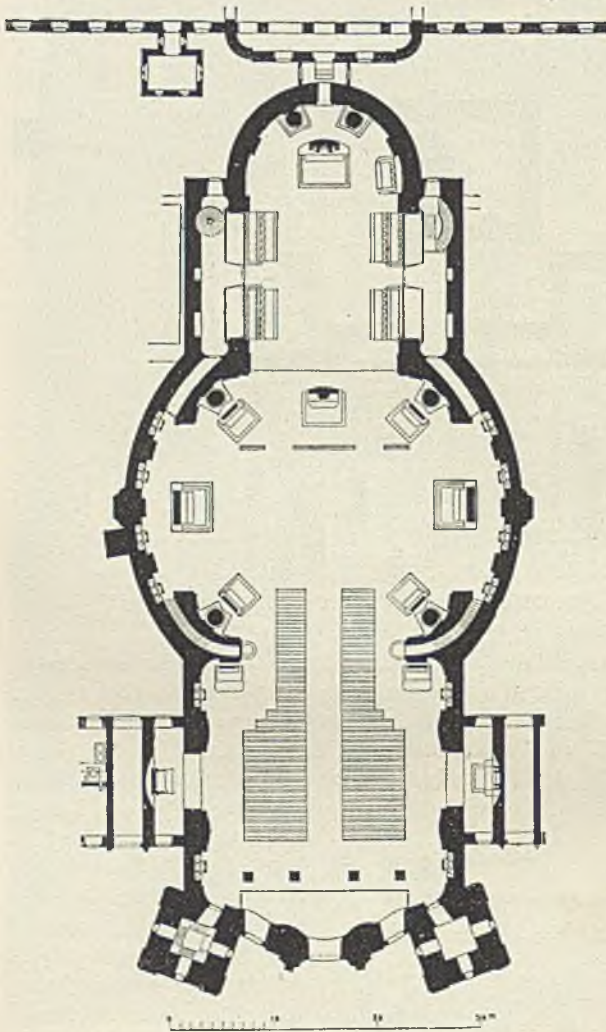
Grundriß der Klosterkirche zu Wiblingen
